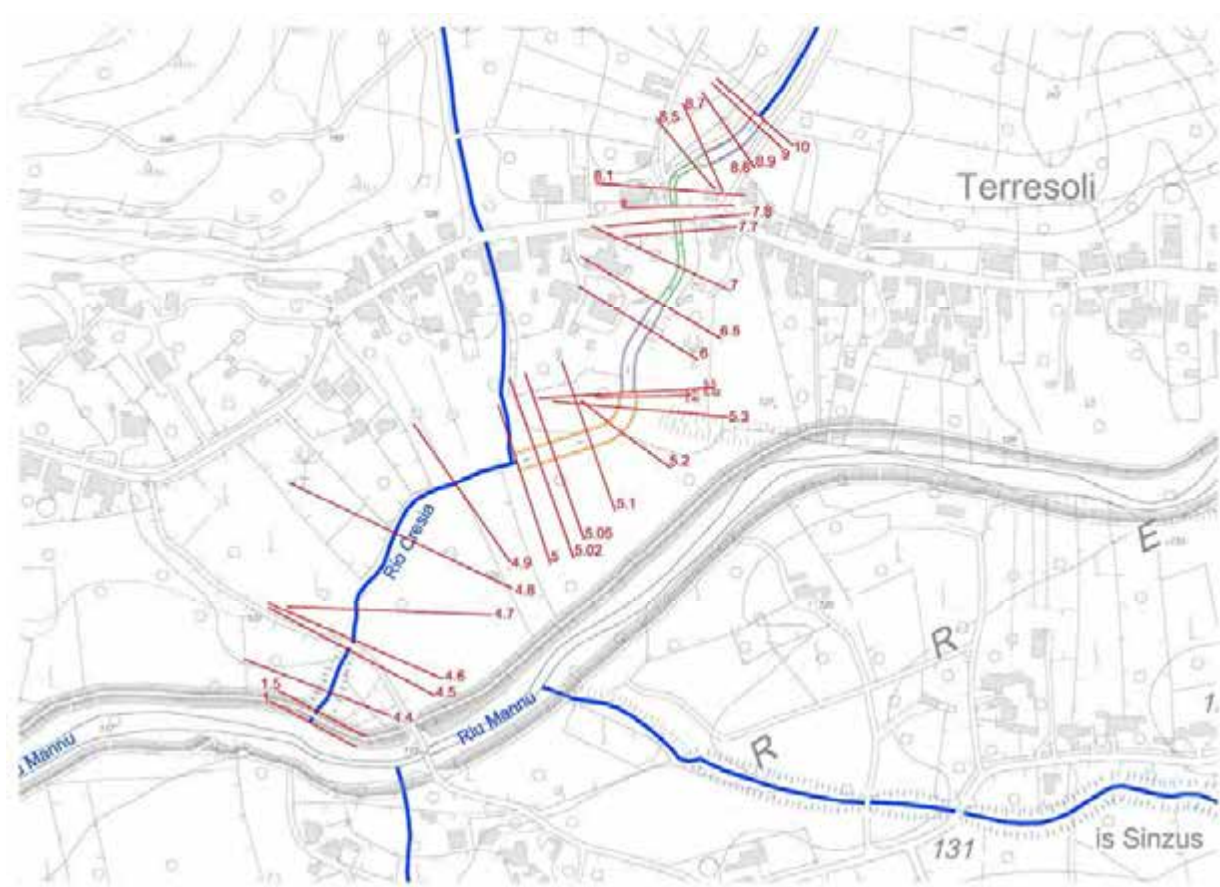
Planimetria con indicazione delle sezioni del corso d’acqua
